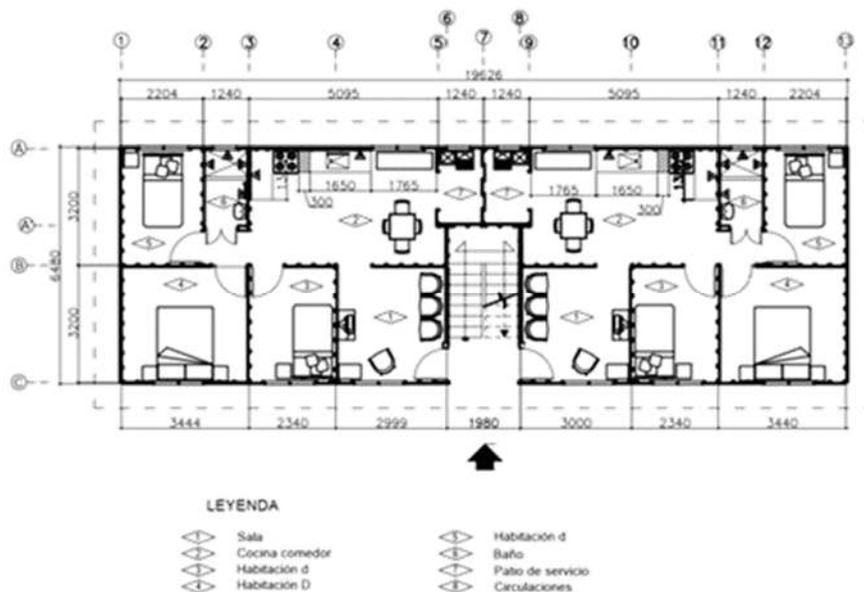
Planta del bloque de cuatro viviendas económicas de tres habitaciones cada una. Edificación de dos niveles proyectada empleando el sistema constructivo SERF.
